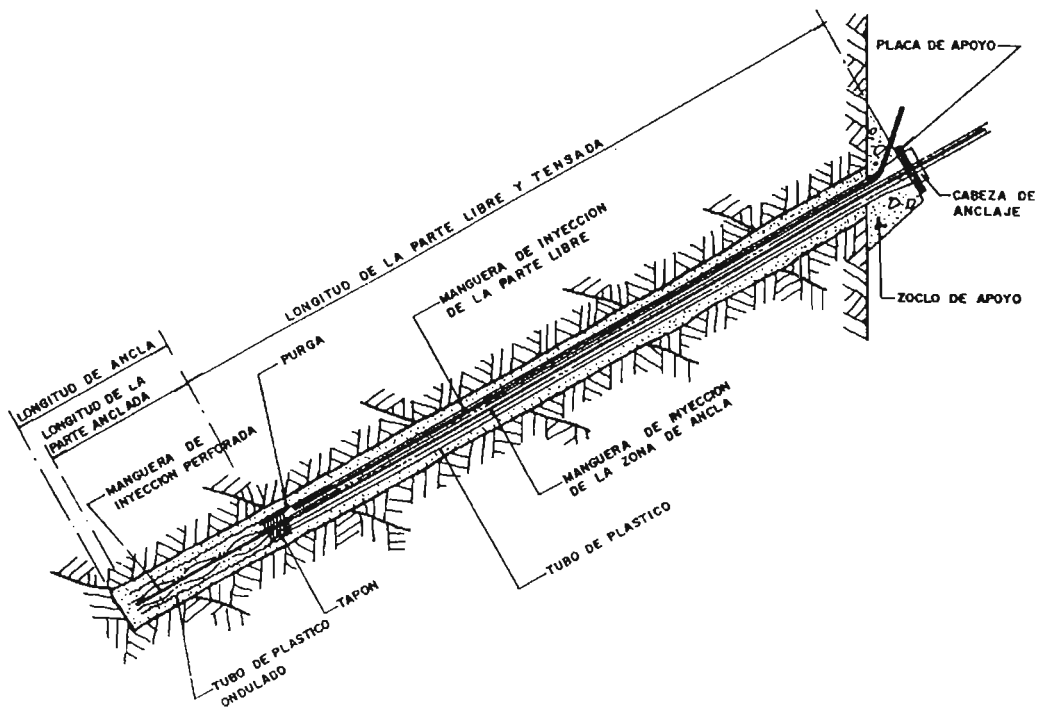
Tirante anclado en roca fisurada.
